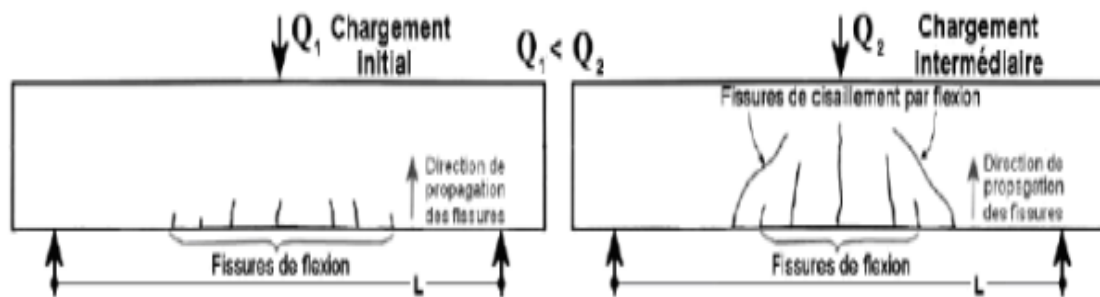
Représentation de la fissuration initiale et intermédiaire par flexion d'une poutre en béton armé (Hamri, 2015).
